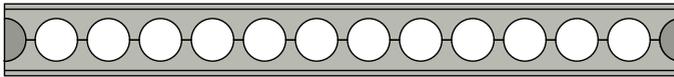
Fabrication d'une poutre cellulaire à ouvertures circulaires avec montants d'extrémité larges
